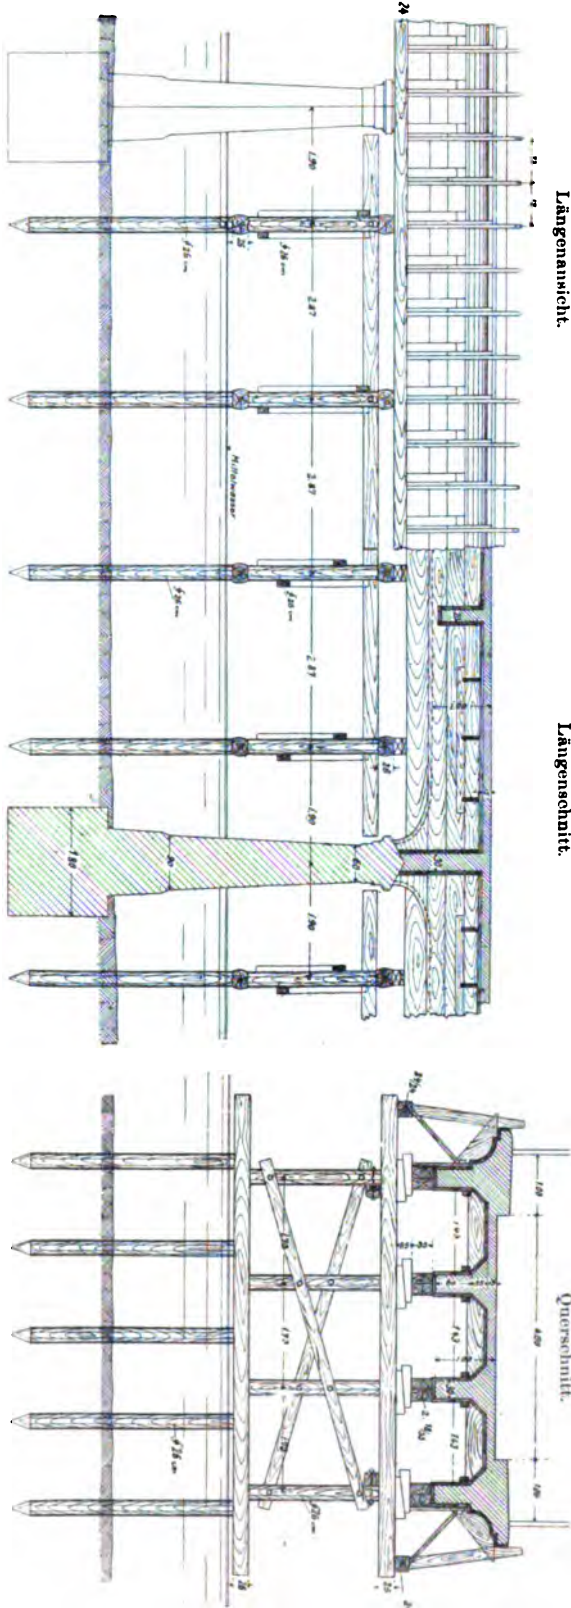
Eingertung der Straßenbrücke über die Donau bei Blochingen.
